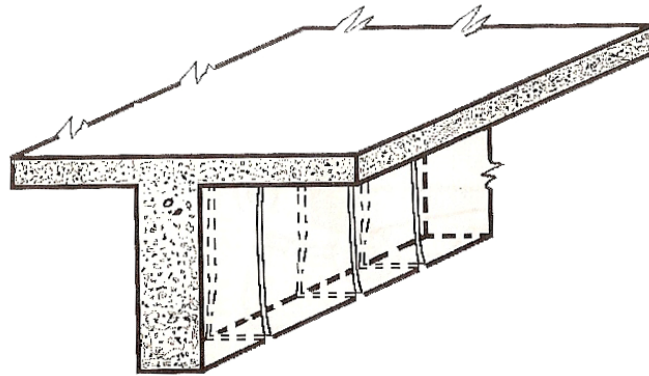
Fissuras de retração por secagem em vigas (Souza, 1999).
